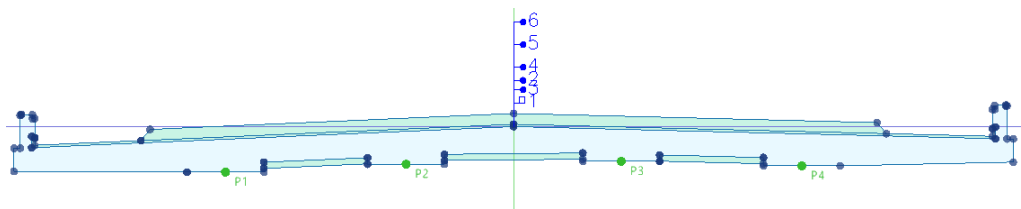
Secção corrente final e pontos de referência para as vigas
